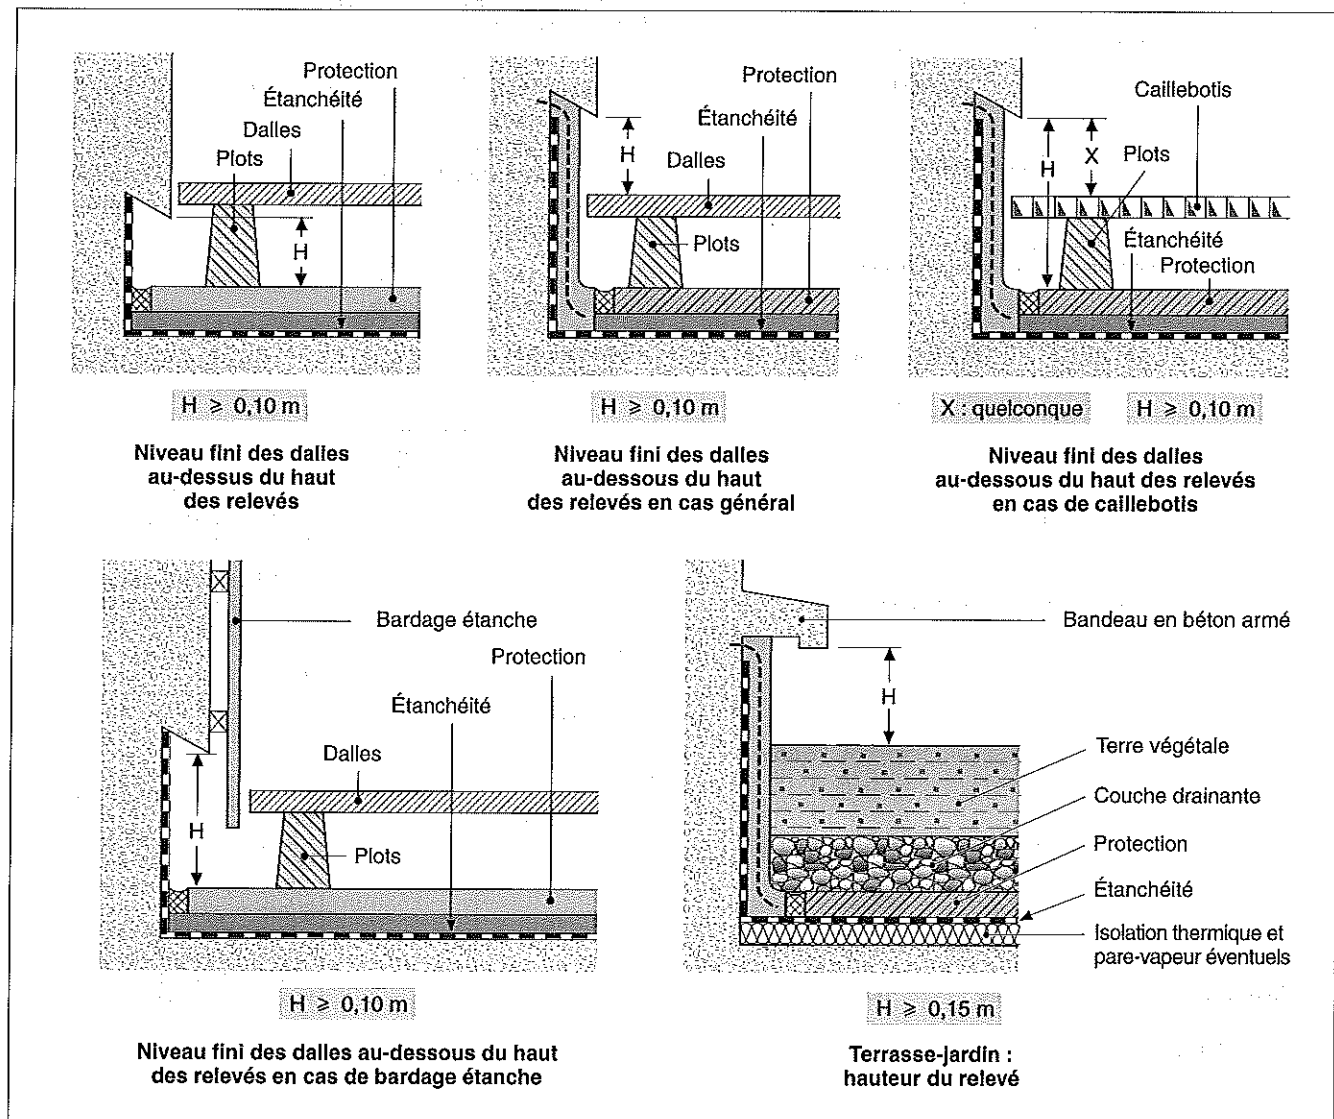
Hauteur du relevé dans le cas des toitures-terrasses accessibles avec dalles sur plots et des toitures-terrasses jardins.
